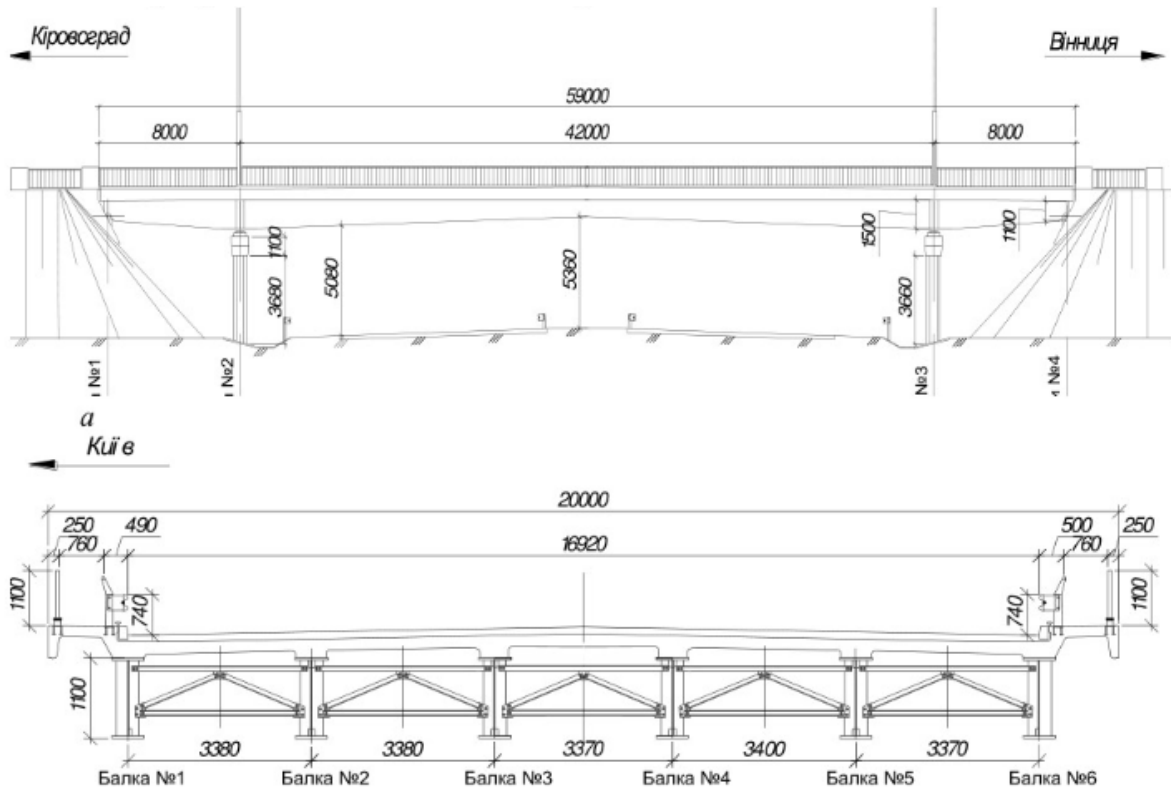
Фасад шляхопроводу на автодорозі Київ-Одеса км 209 (а) та його поперечний переріз (б)
